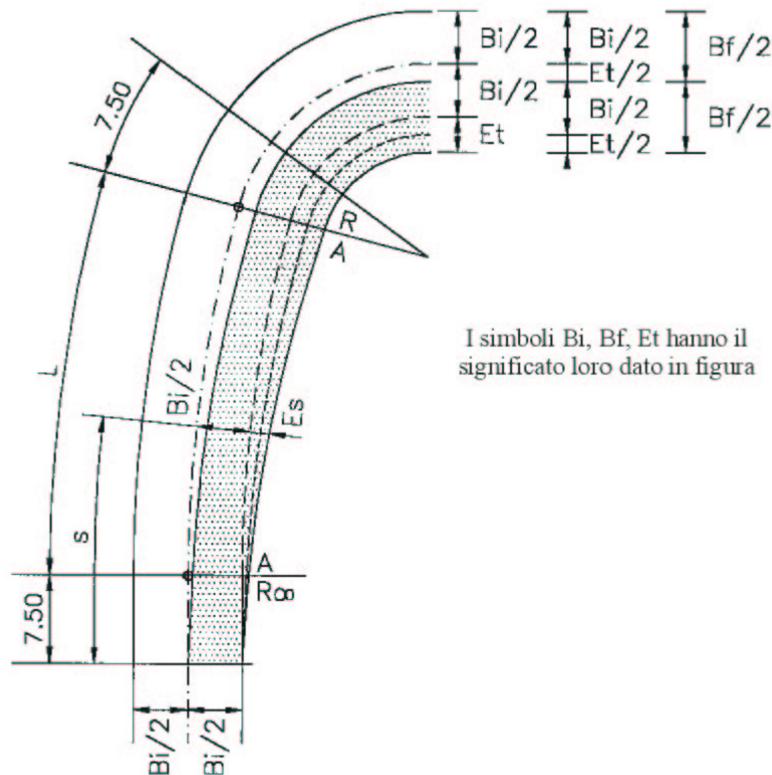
Modalità di introduzione dell'allargamento in curva.
